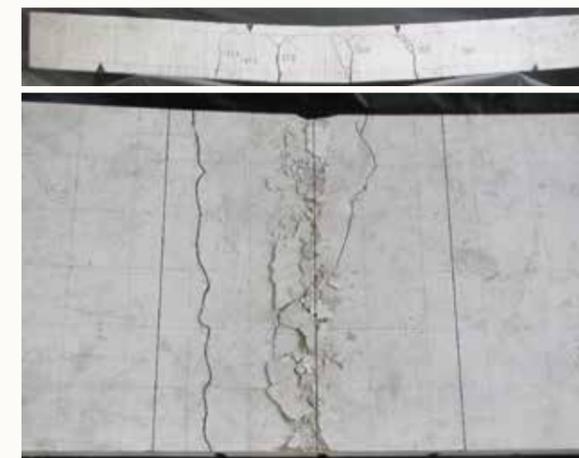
ビス穴なし試験体の破壊状況(上:側面 下:平面)
